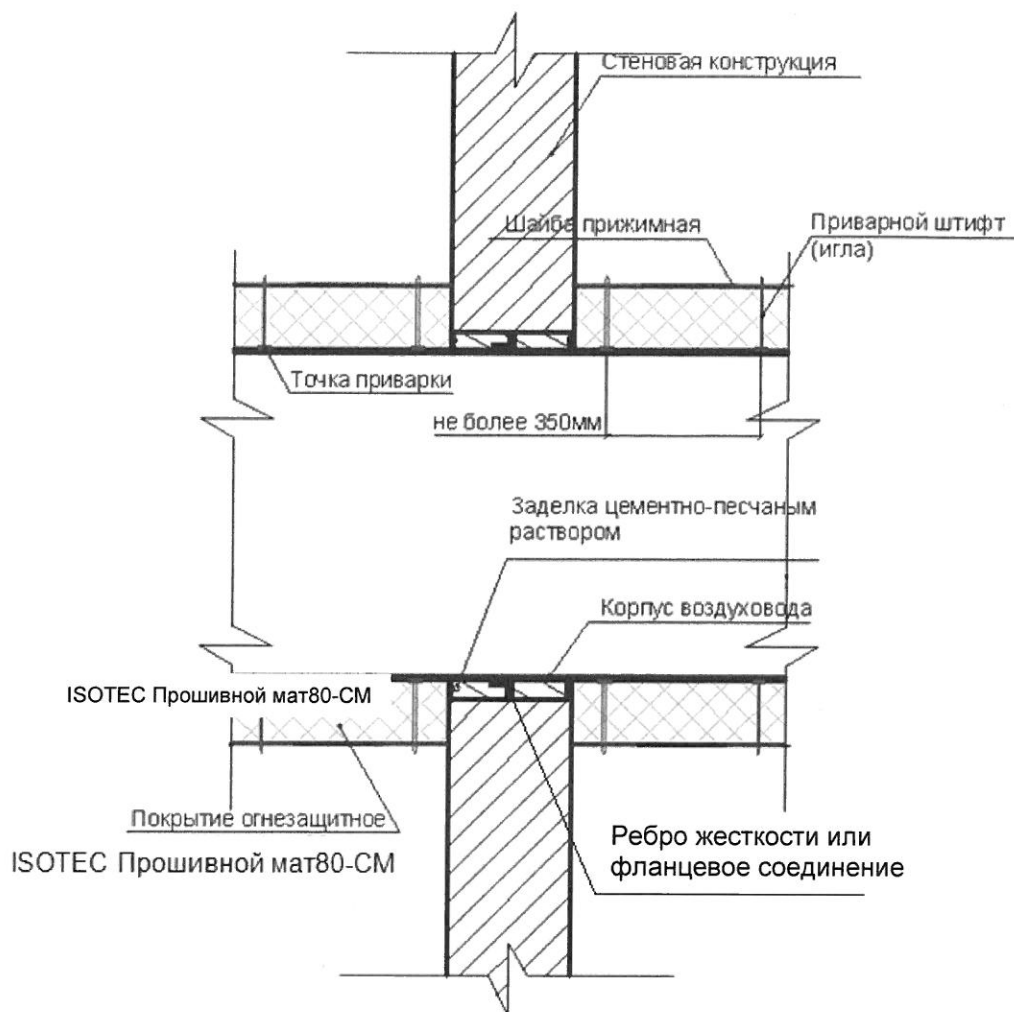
Принципиальная схема пересечения воздуховодом строительной конструкции
